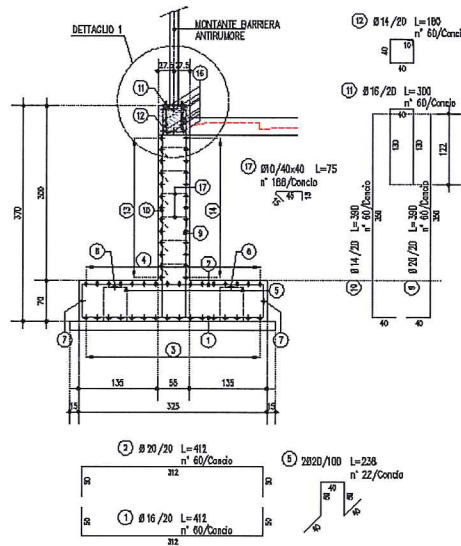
Schema armatura – Muro tipo 2 –Conci 6-14
